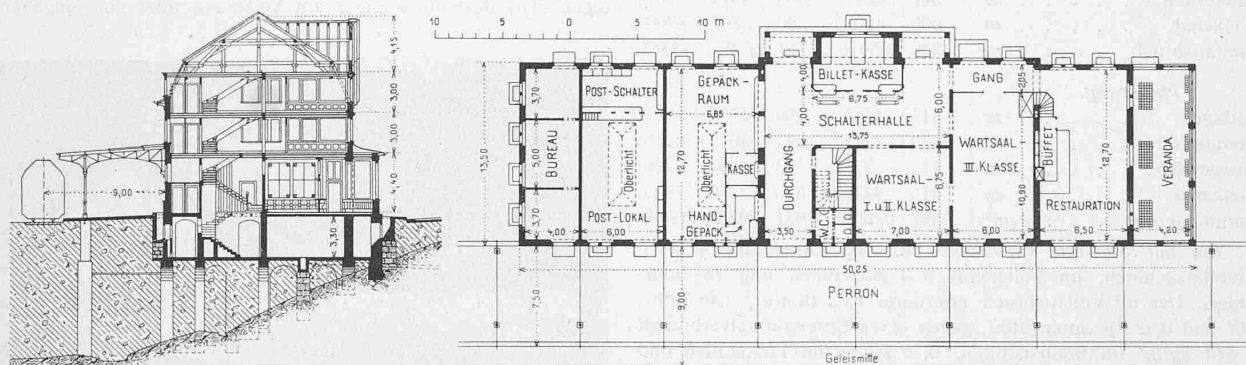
Schnitt in Gebäudemitte und Erdgeschoss-Grundriss des Aufnahmegebäudes Herisau — Masstab 1 : 500.
